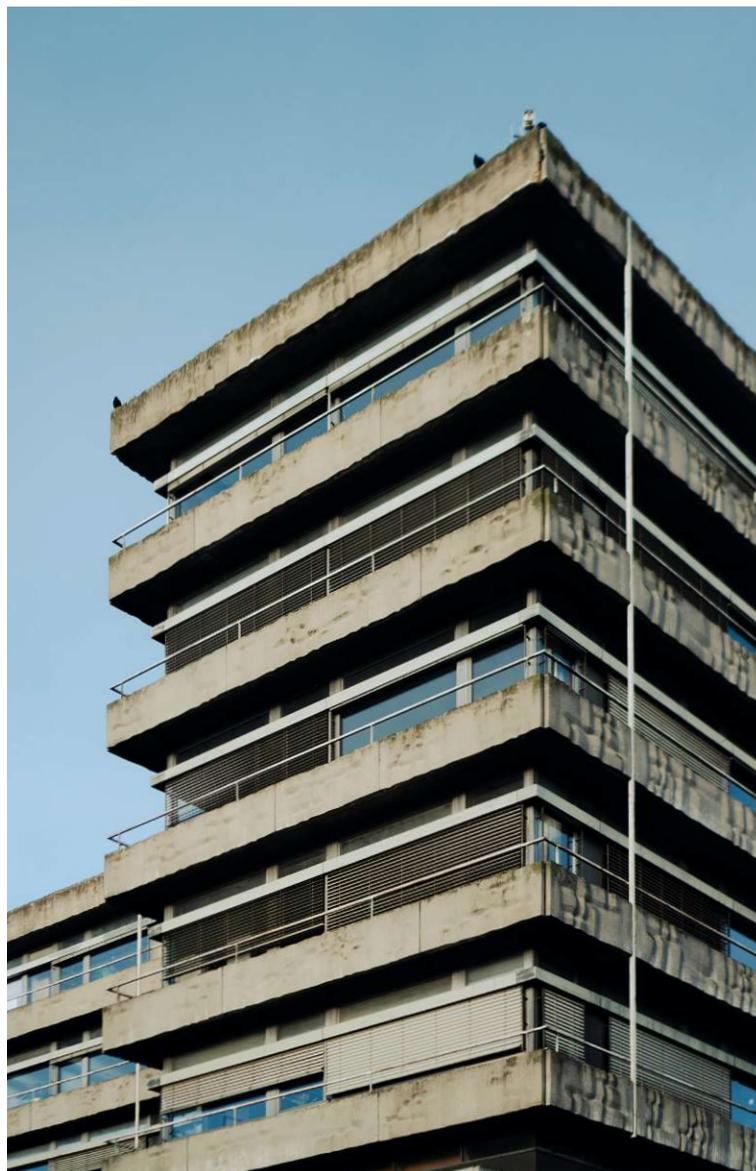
Die Fassade besteht aus Beton-Brüstungselementen und einer Bandfassade mit Oberlicht und integriertem Sonnenschutz.
